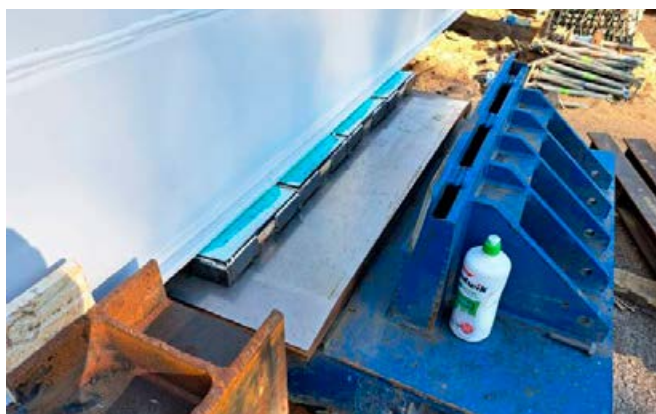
Montaż konstrukcji stalowej na leżni za przyczółkiem P4
